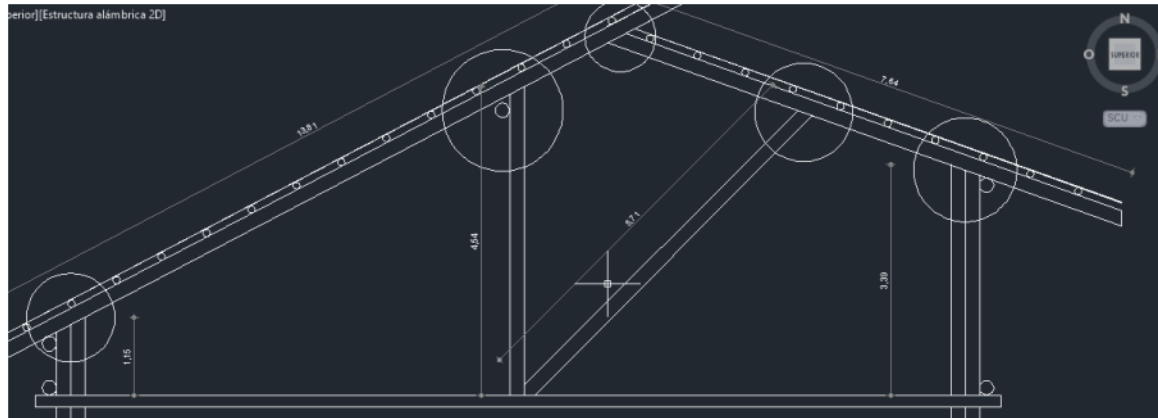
Nudos estructurales para la aplicación de la carga vertical.
